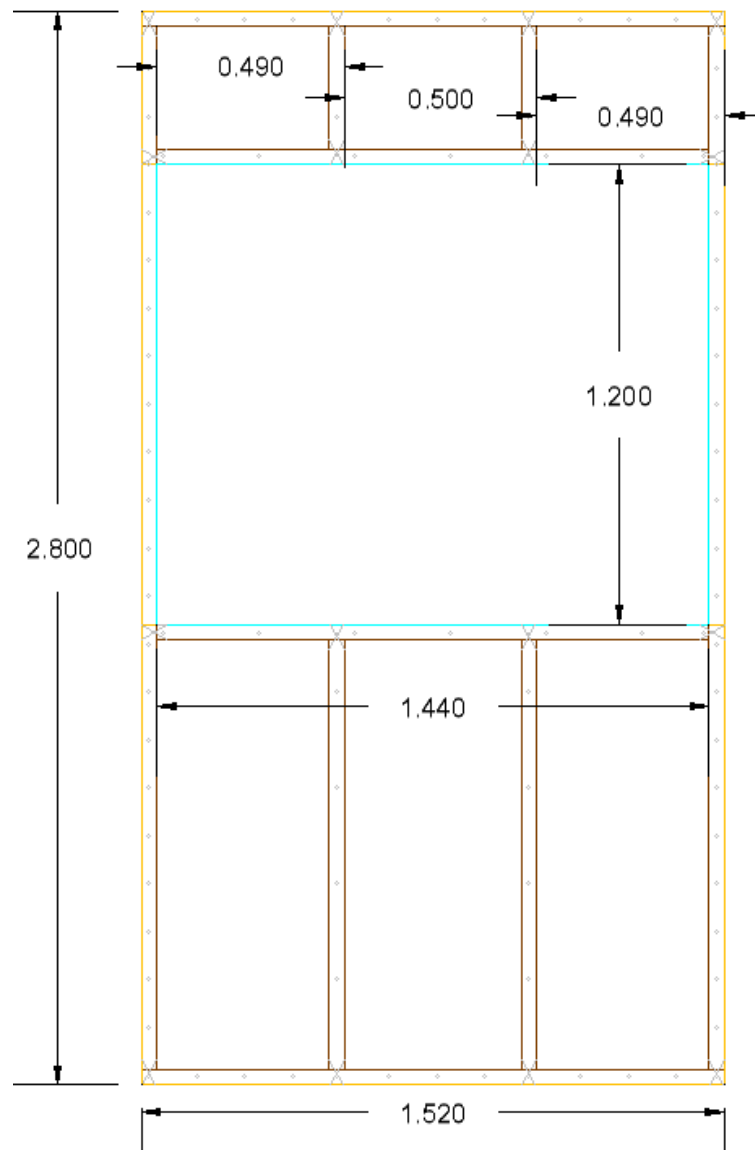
, Muro no estructural M8 1.52 x 2.8
